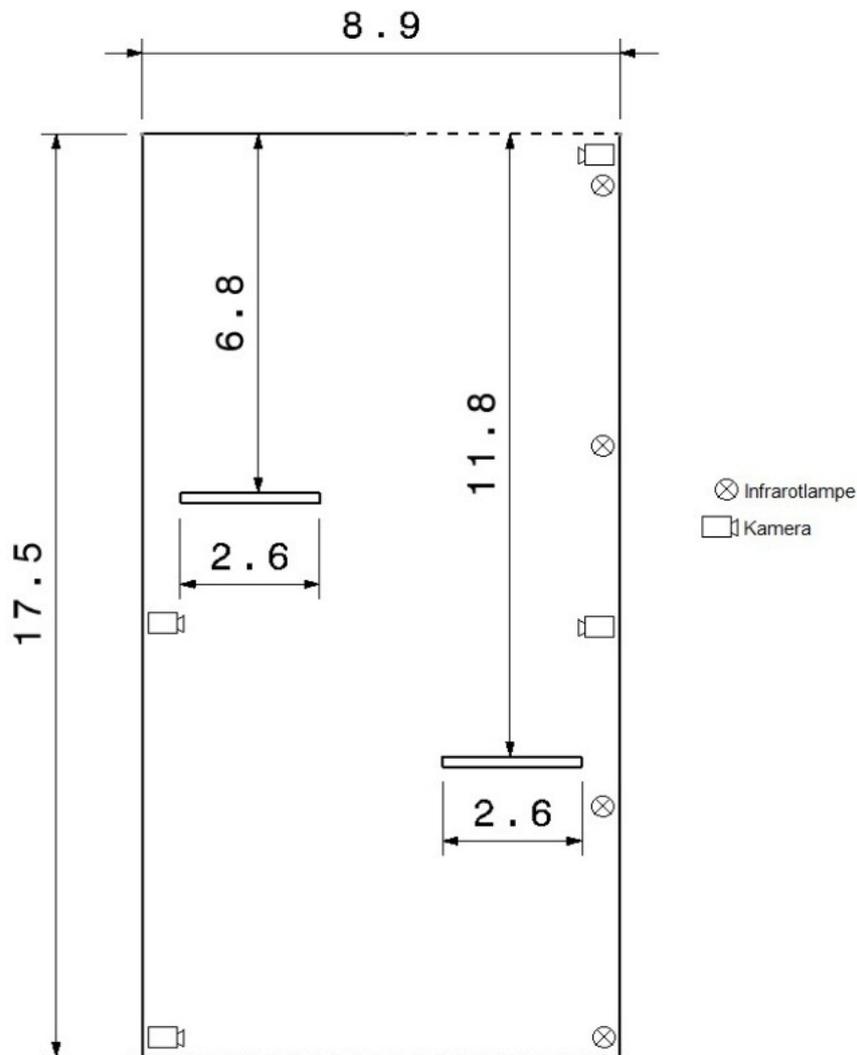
Grundriss des Stalls auf der Brente (inkl. Strukturelementen, Kameras und Infrarotstrahlern; Angaben in m)
